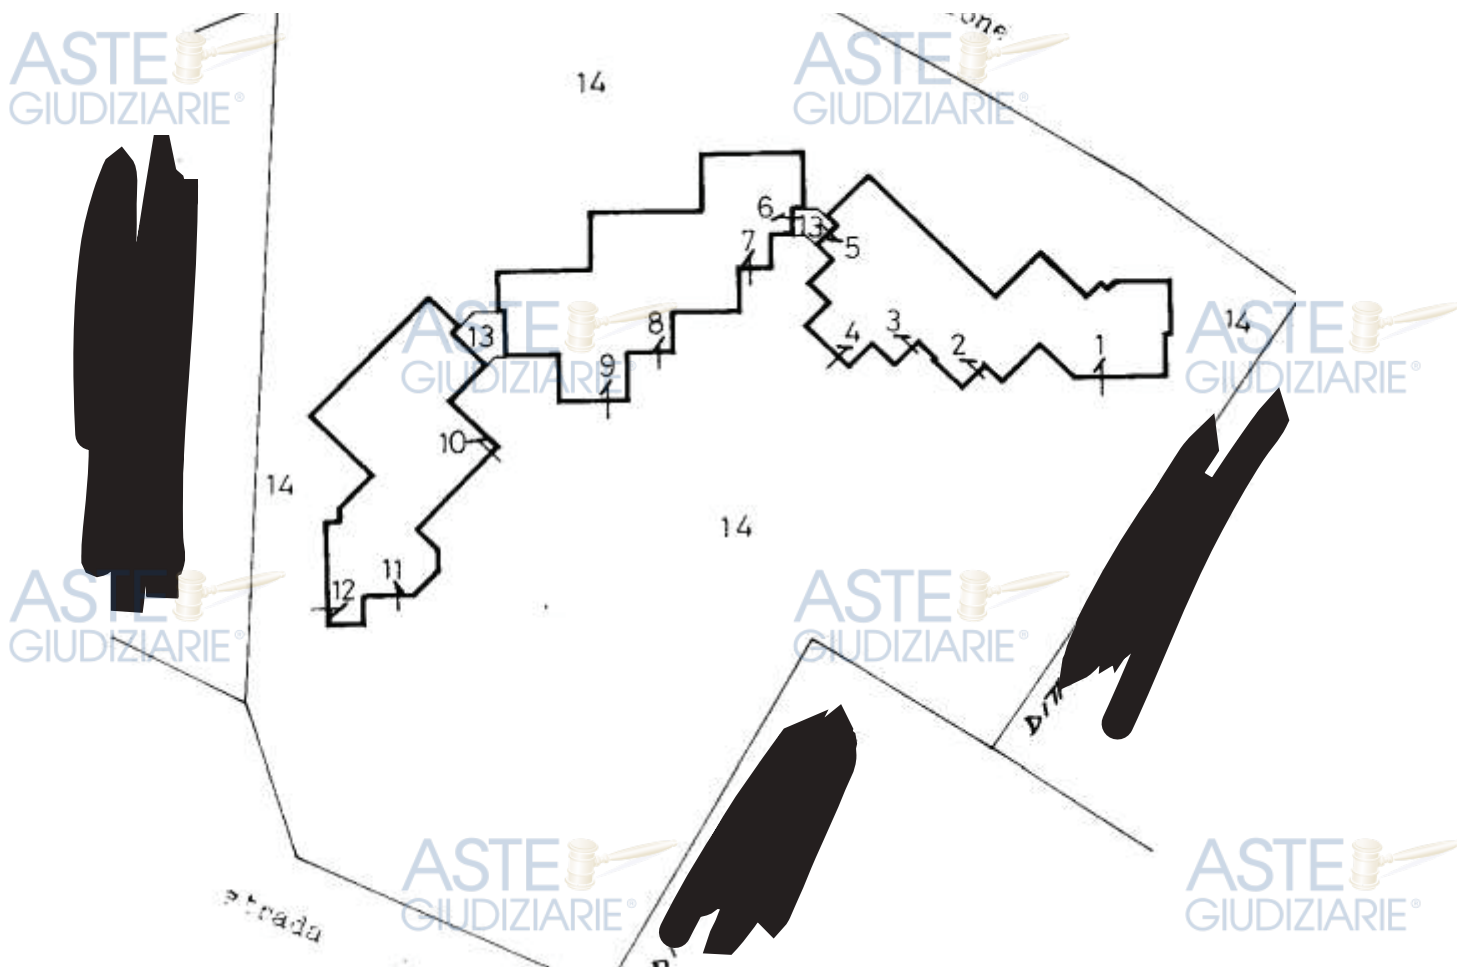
Ubicazione planimetrica dei beni immobili pignorati GRUPPO A30 APPARTAMENTI
